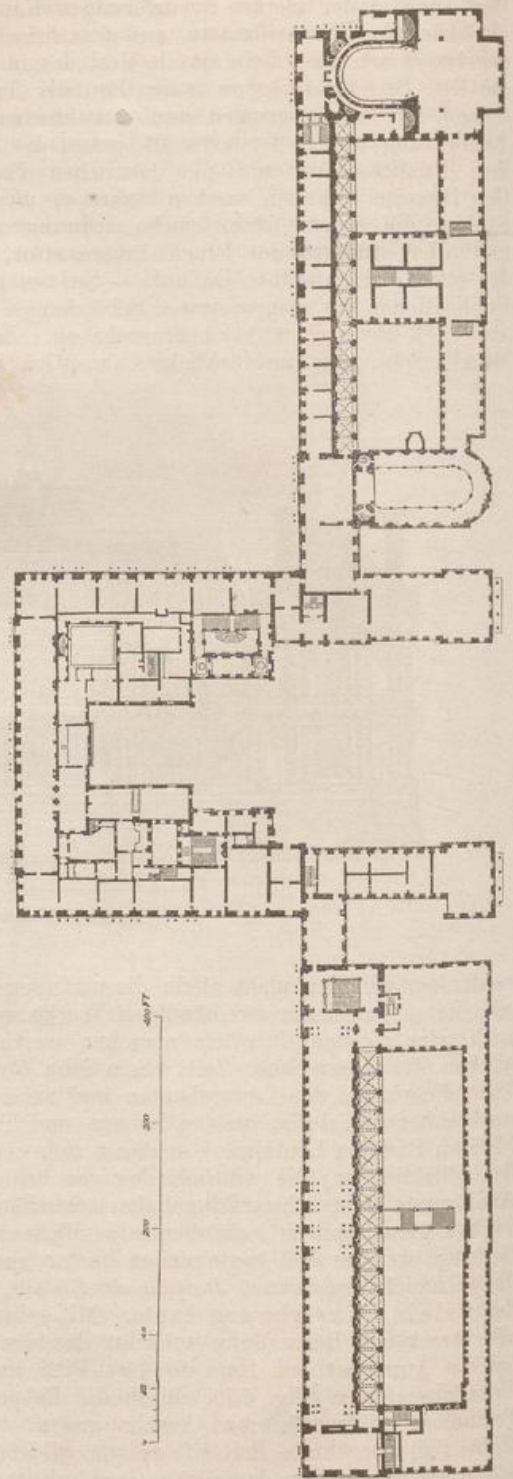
Grundriss des Schlosses von Versailles.
